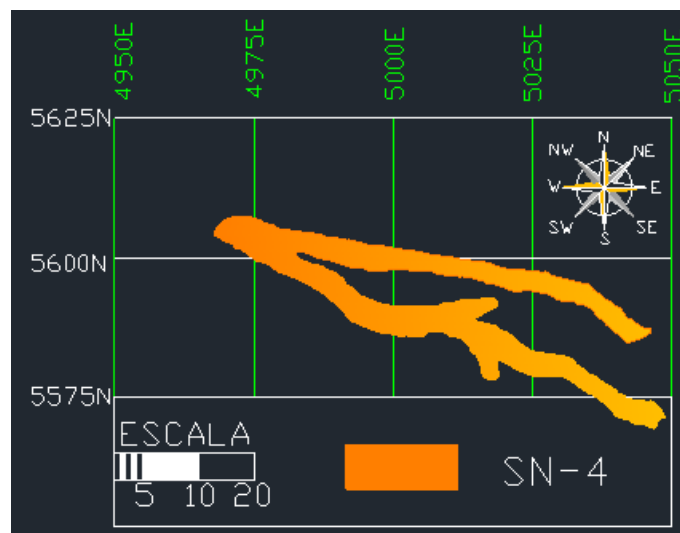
Proyección en planta del SN-4 inclinado entre las elevaciones 2285 y 2295
